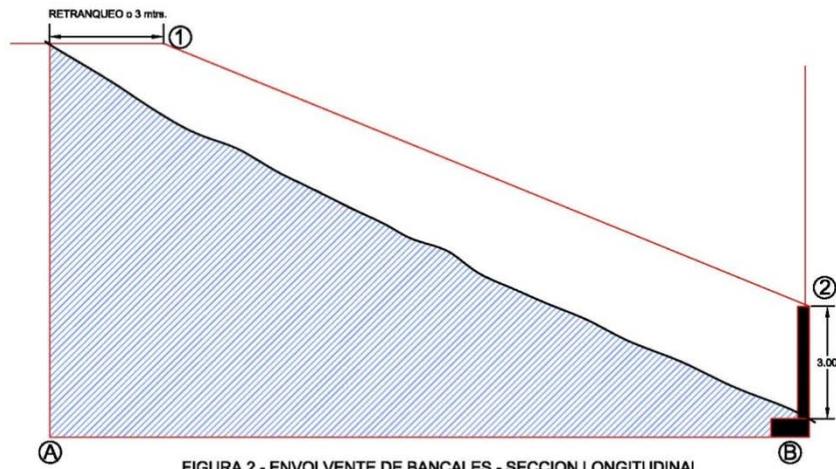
ENVOLVENTE DE BANCALES - SECCION LONGITUDINAL
